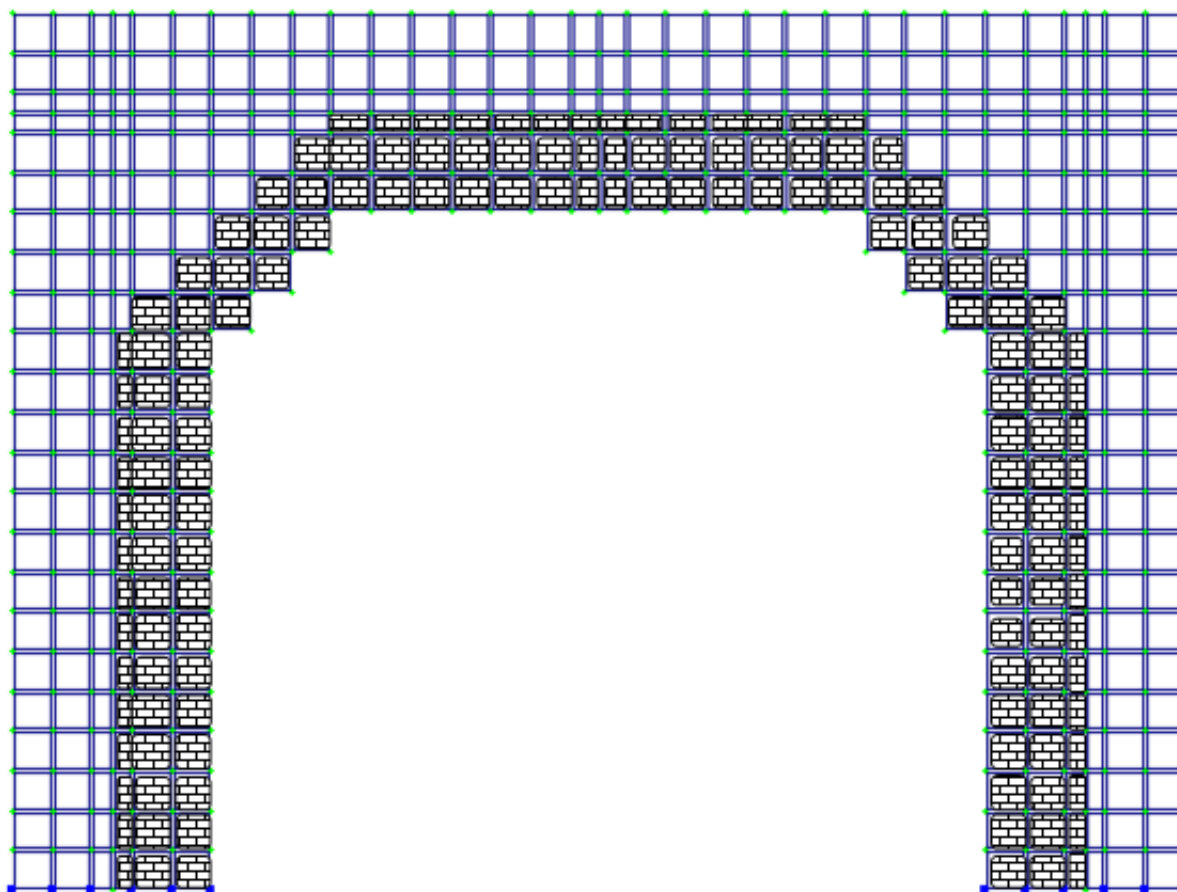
Расчетная модель фрагмента №1 железобетонного фундамента с футеровкой из шамотной кладки
